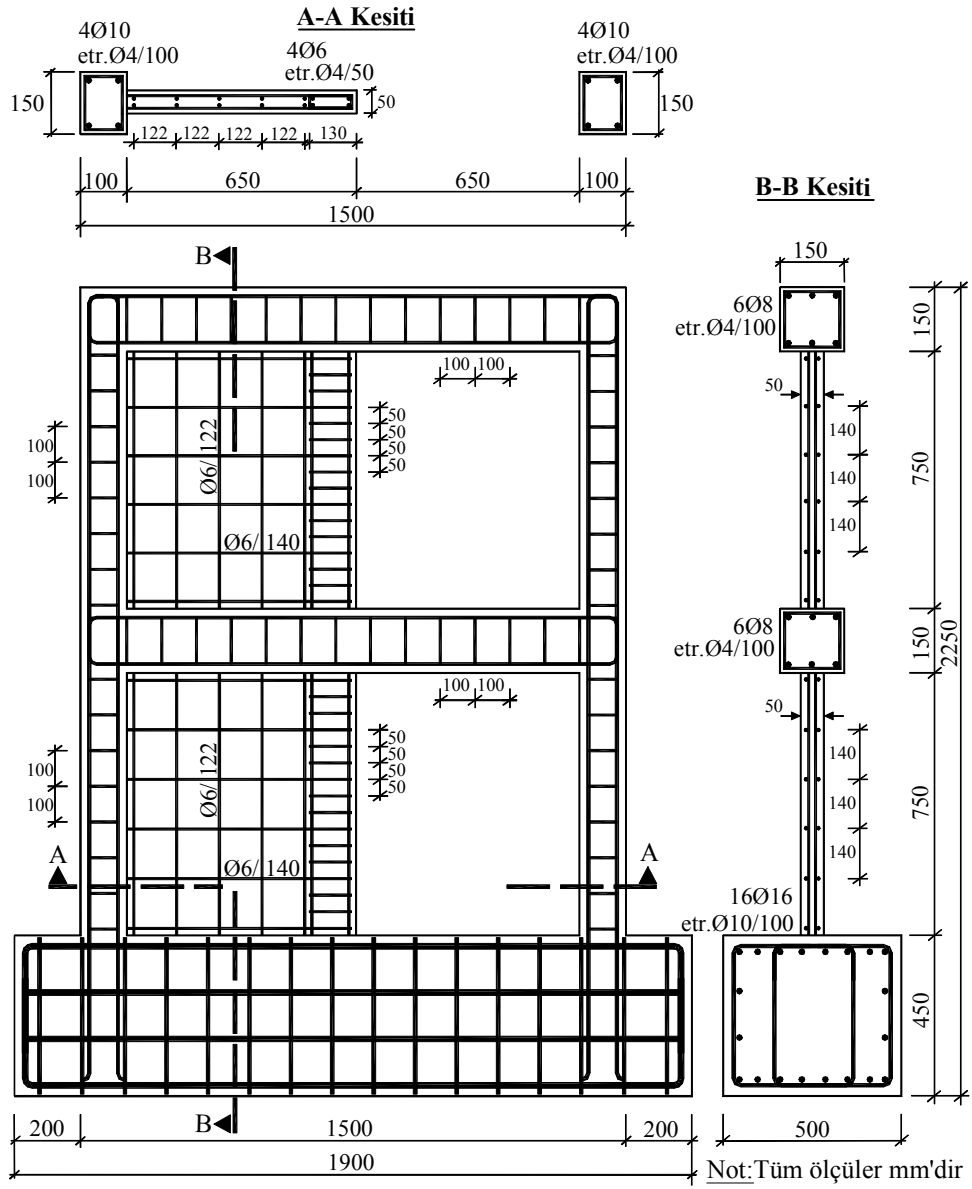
Deney Elemanı-3'ün filiz donatısı detayı
